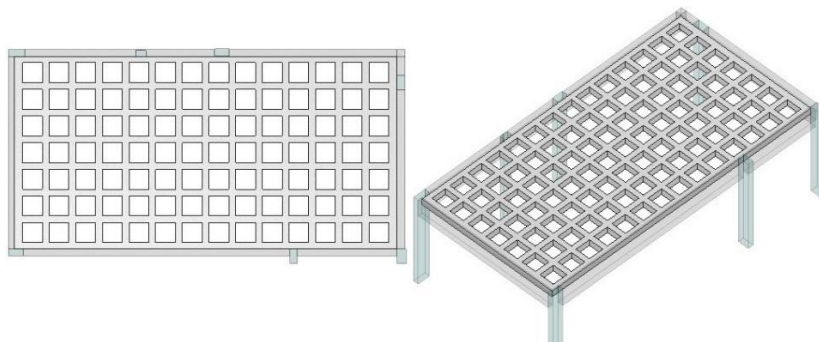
Laje L8 nervurada bidirecional em planta e em perspectiva. (Fonte: AUTORIA PRÓPRIA; 2023)
